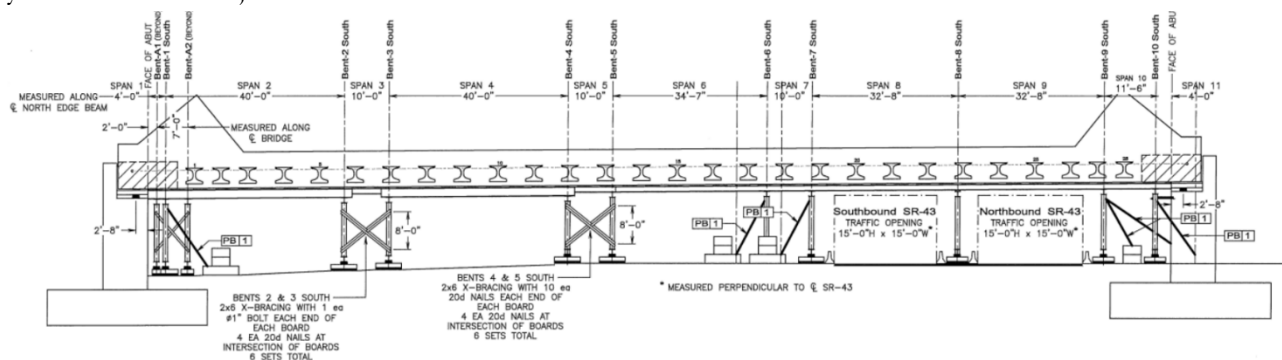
Detalle de la cimbra de las vigas tirante y de las vigas transversales.
